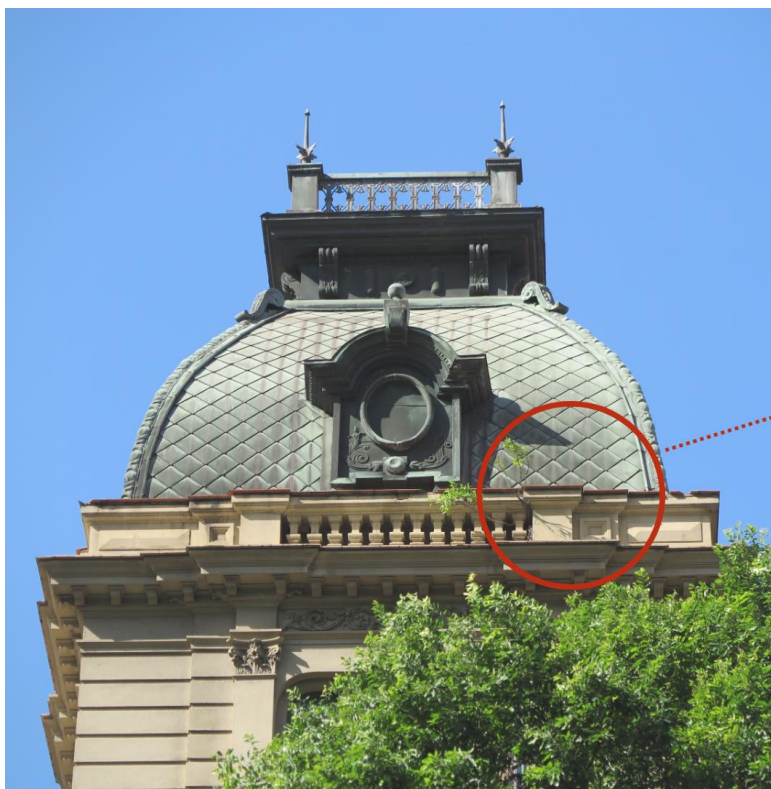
Detalhamento de Danos: Trinca grave na argamassa, gerando infiltração na alvenaria, perigo de queda de partes de argamassa.
